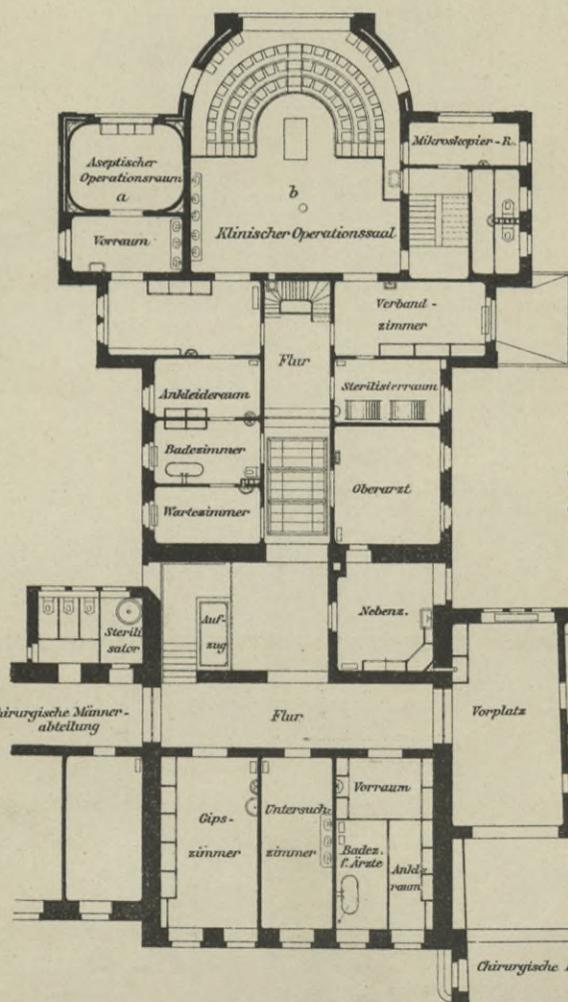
Grundriß des I. Stockwerks. 1:333 1/3.
